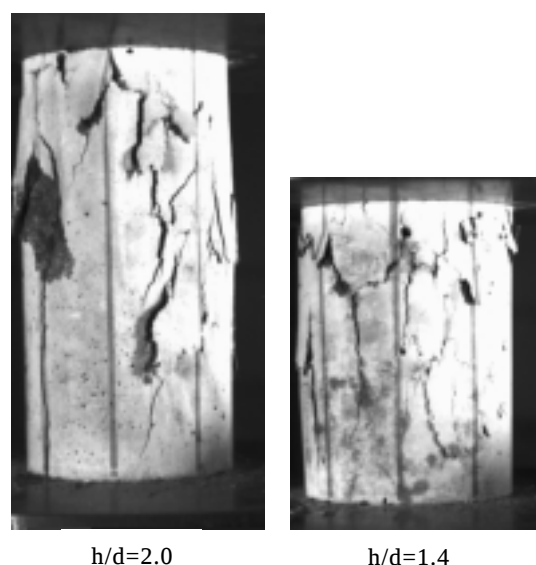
圧縮強度試験における破壊時のひび割れ状況 (W/C=40%、 ϕ 100mm)
